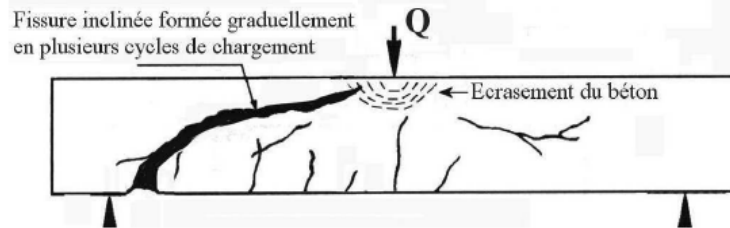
Schéma typique d'une poutre en BA endommagée par la compression due au cisaillement.
